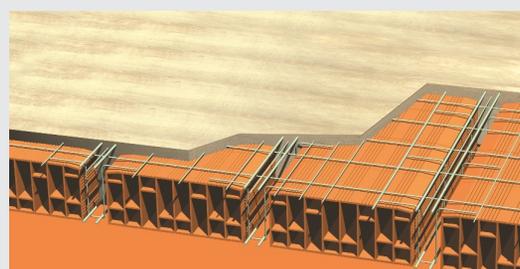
Forjado unidireccional con nervios hormigonados "in situ"
